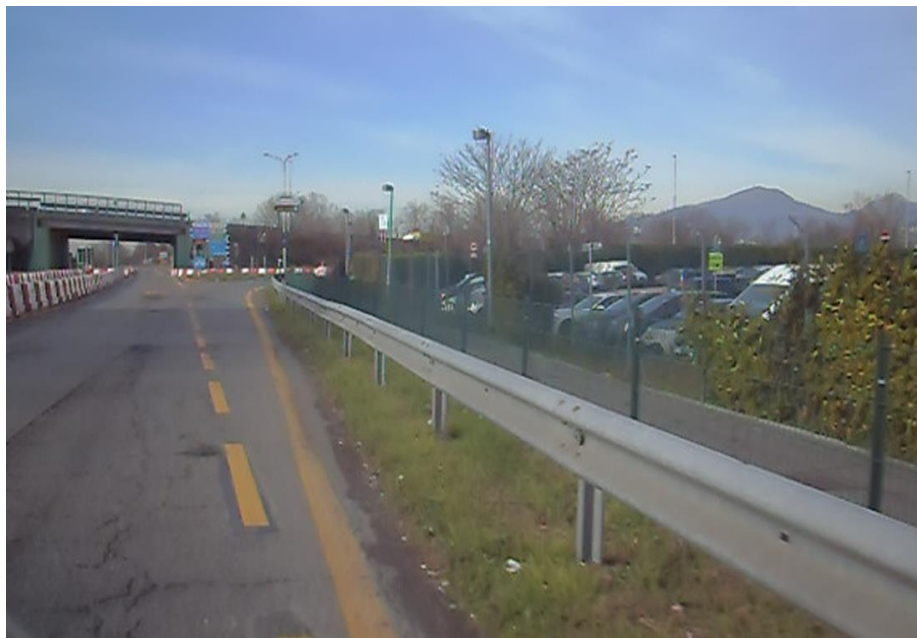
Vista del cantiere CO.04 dalla SP116 (fonte sopralluogo)
